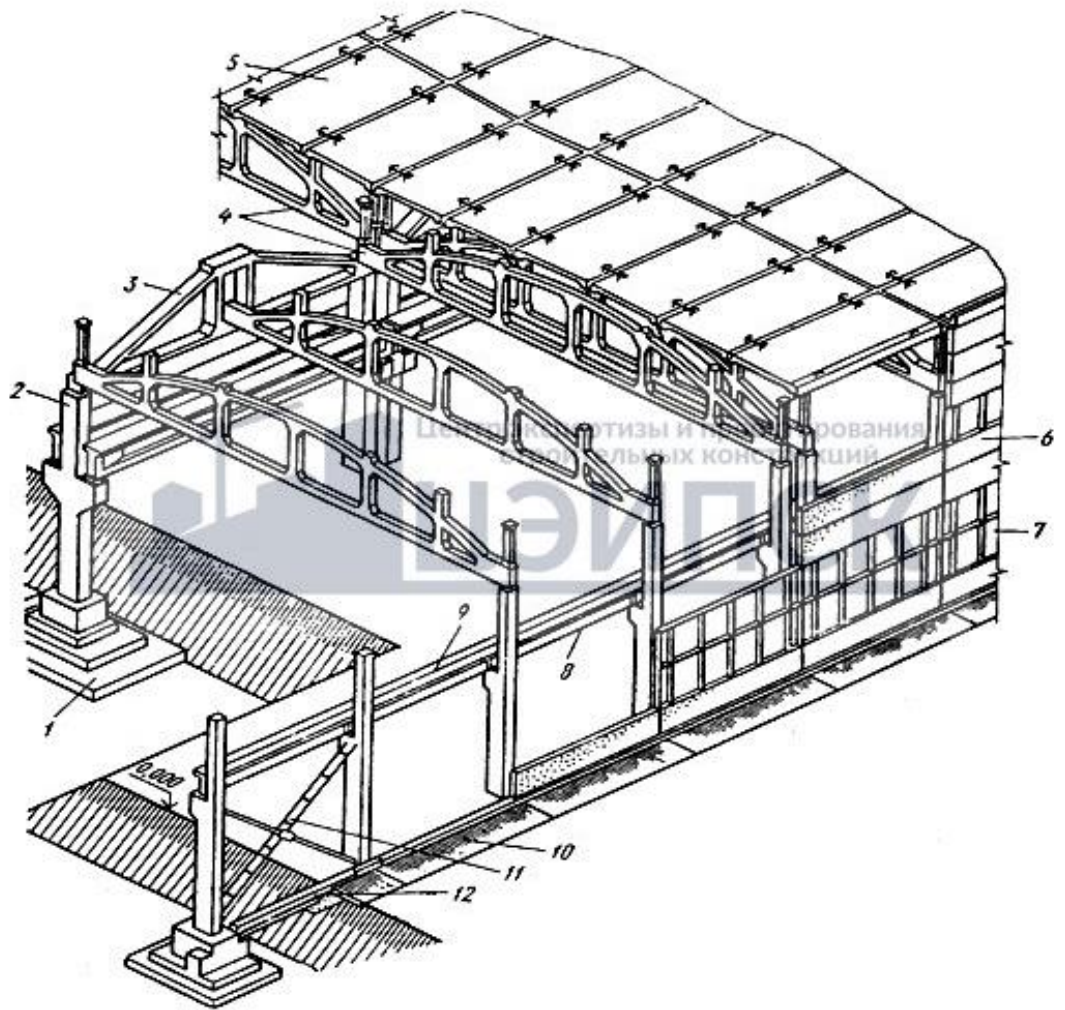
Покриття промбудівлі із залізобетонних ребристих плит
